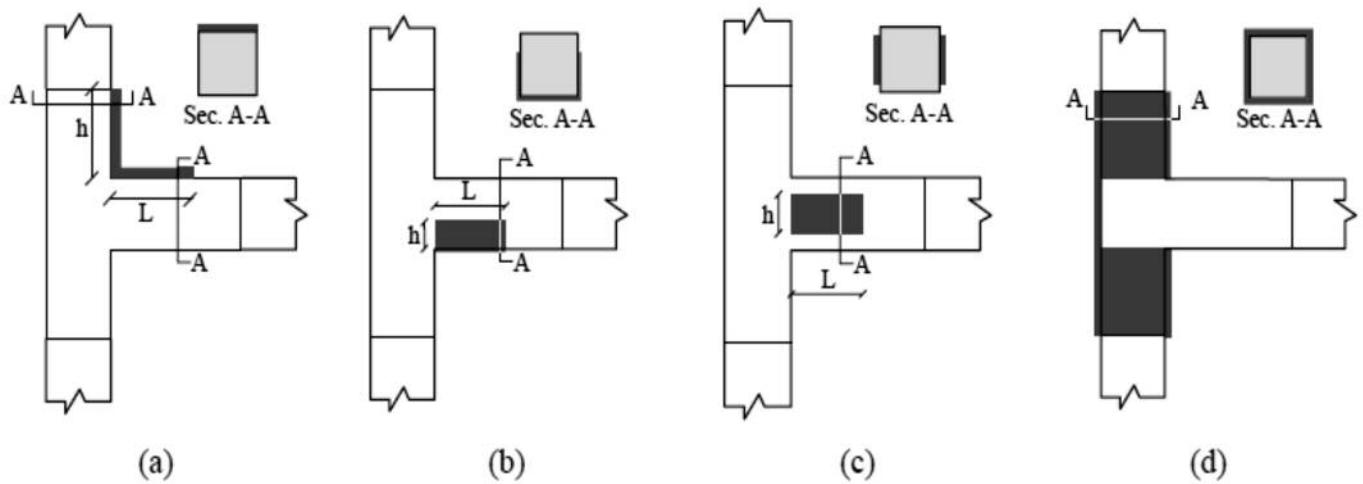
Formes de renforcement des nœuds poteaux poutres
